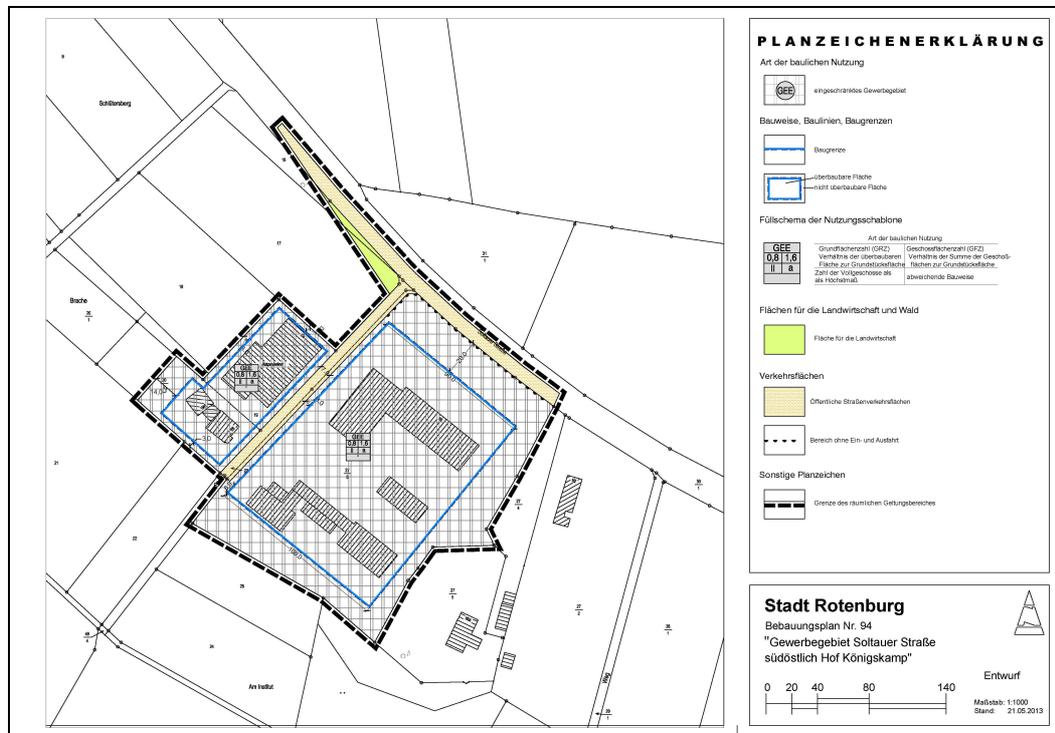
Bebauungsplan Nr. 94 (Entwurf)
